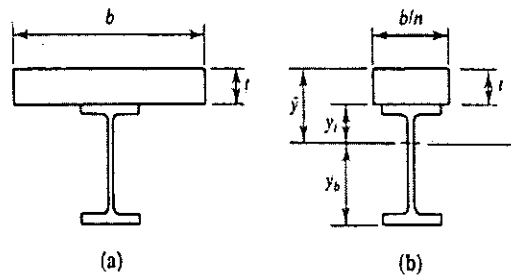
Ancho Efectivo de la Sección Compuesta
